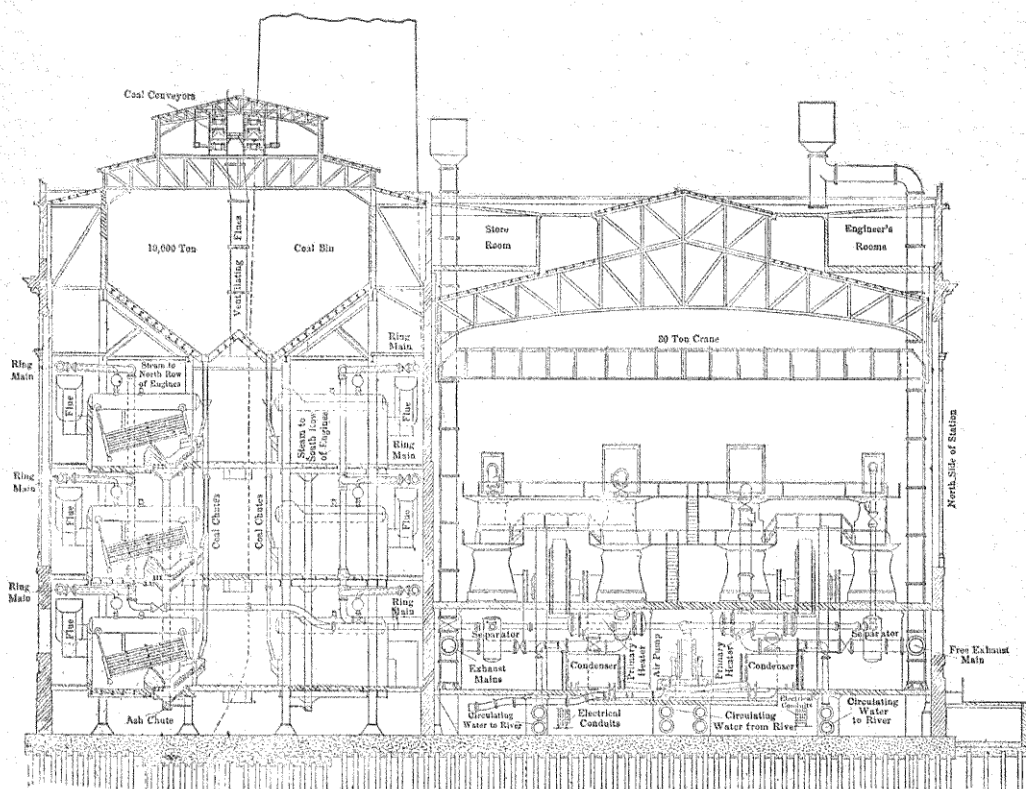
Station centrale du Metropolitan Railway de New-York.
